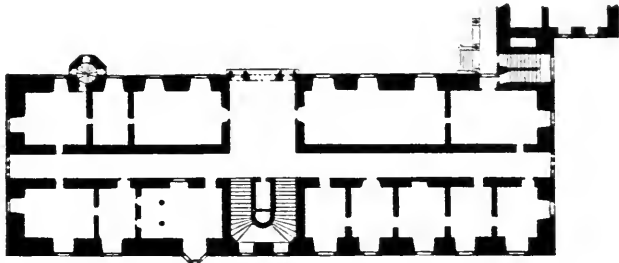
Grundriß des Erdgeschosses vom Schloß zu Baden.
